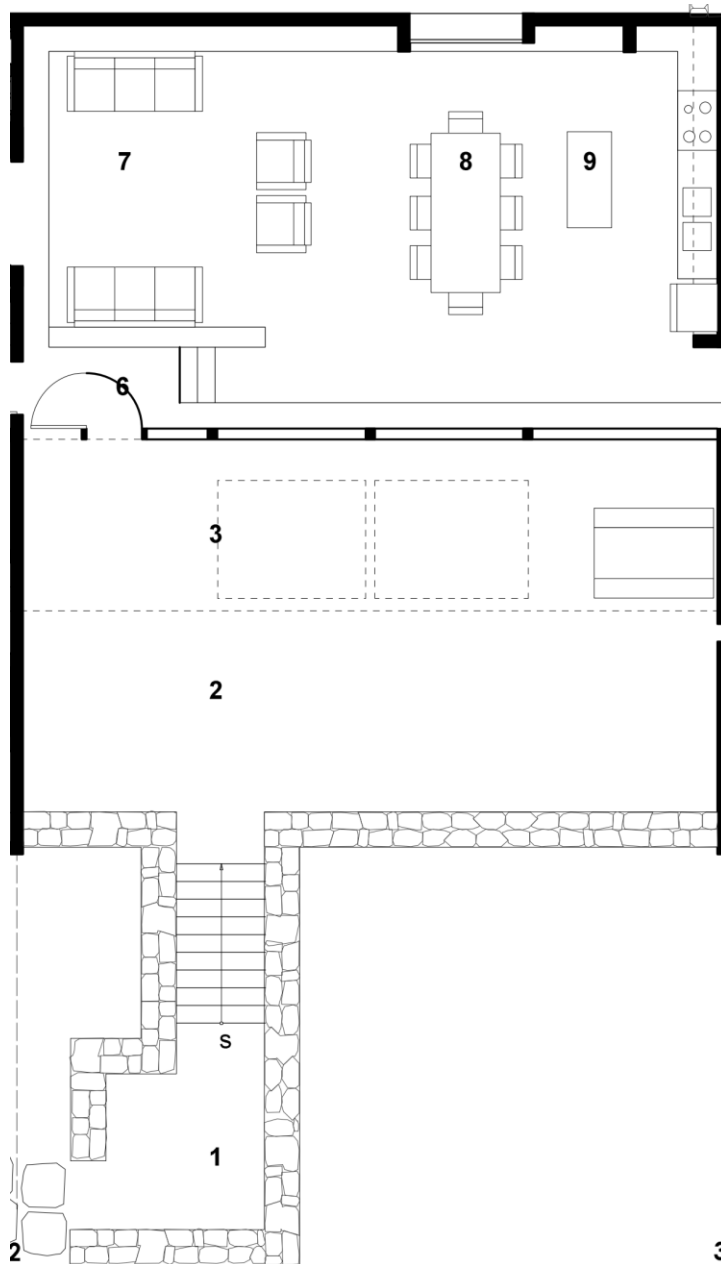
Planta baja, zonificación bloque 3. Fuente: Autor.
